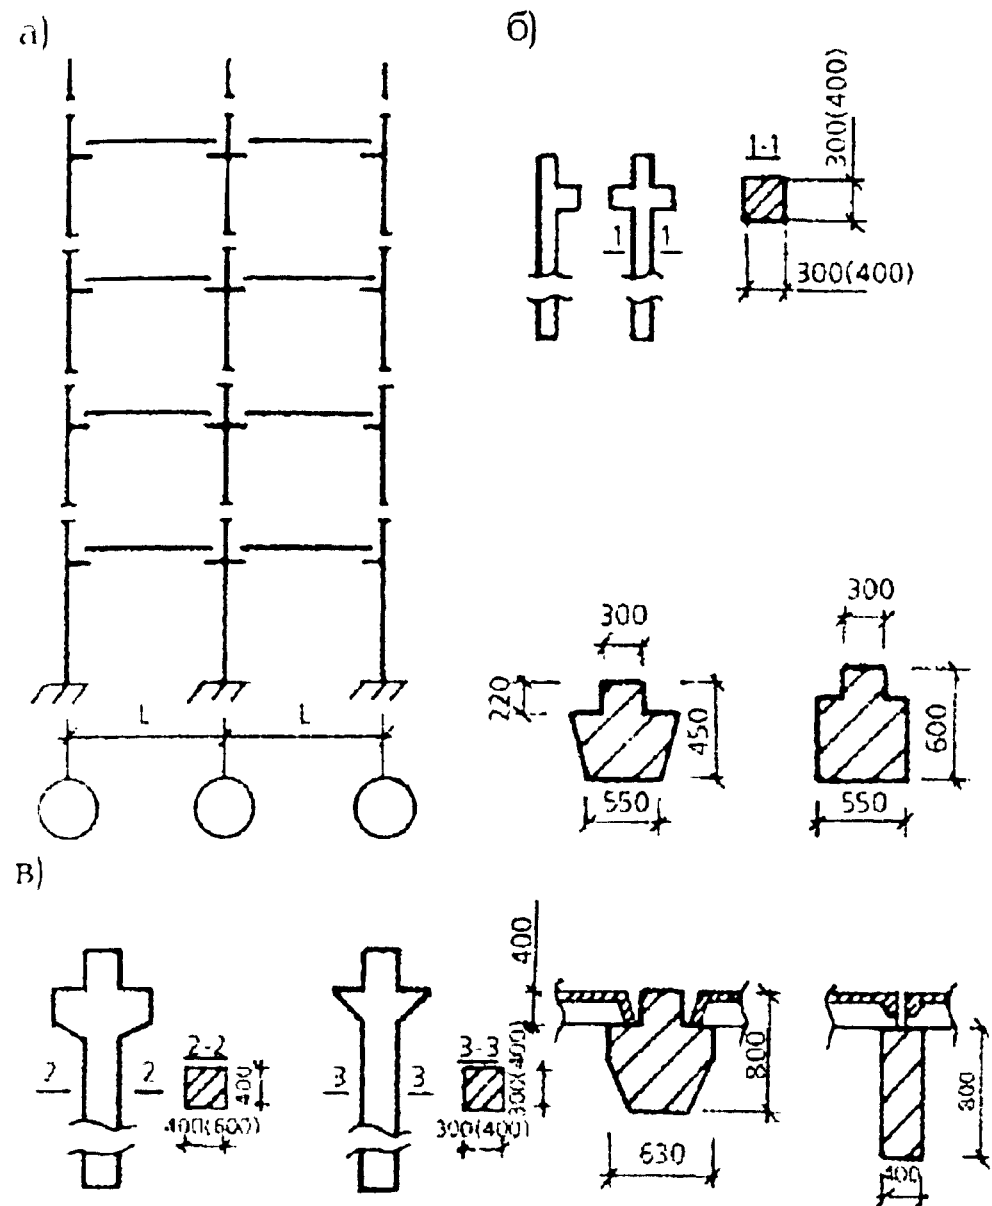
Стоечно-балочный каркас. Элементы: а - схема поперечной рамы каркаса; б - колонны и ригели гражданских зданий; в - колонны и ригели промышленных и сельскохозяйственных зданий
